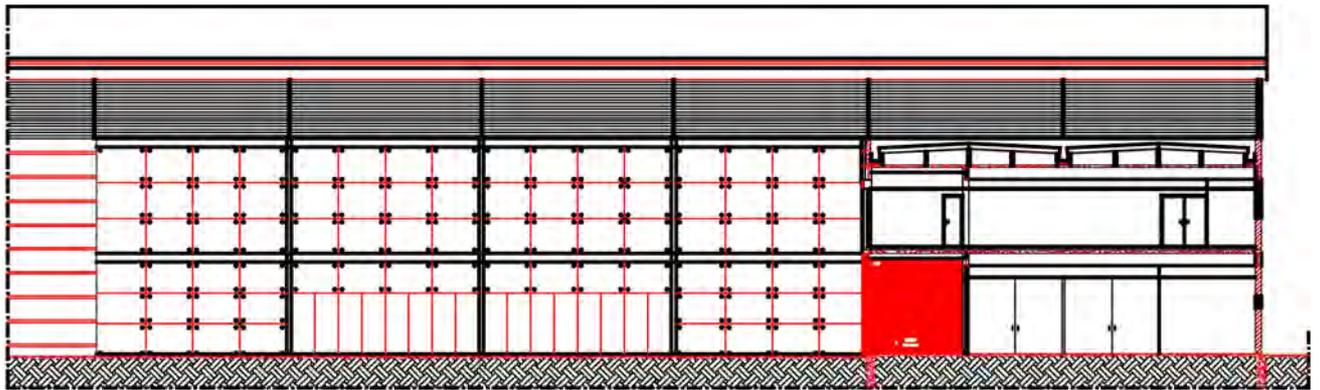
Projeto de fachada e imagens da face posterior – rodovia /Projetos de fachadas e imagens das docas de exposição e teatro.
